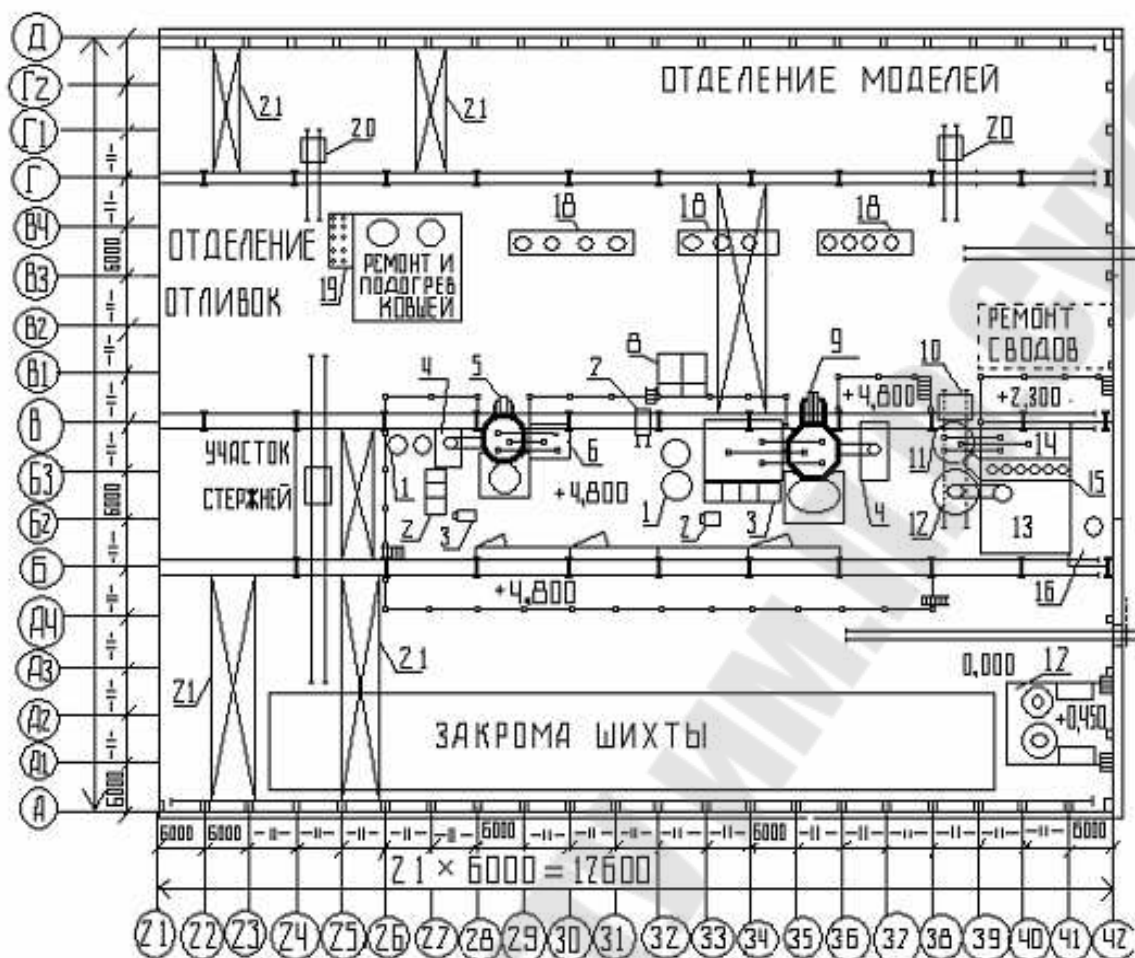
План расположения ДСП-40 и АКВОС в сталелитейном цехе в осях: А-Д; 1- место размещения бадей и корзин; 2- коробка; 3- весы; 4- дымсос; 5- ДСП-5; 6- силовой трансформатор; 7- печь прогрева ферросплавов; 8- стенд прогрева ковшей перед заливкой; 9- ДСП-40; 10- сталевоз; 11- пост электроподогрева расплава; 12- блок вакуумирования ковша; 13- вакуумные насосы; 14- трансформатор; 15- бункера добавок; 16- воздухозаборник; 17- газификатор аргона и азота; 18- канава; 19- ремонт и прогрев стопоров; 20- передаточная тележка; 21- мостовой кран.
